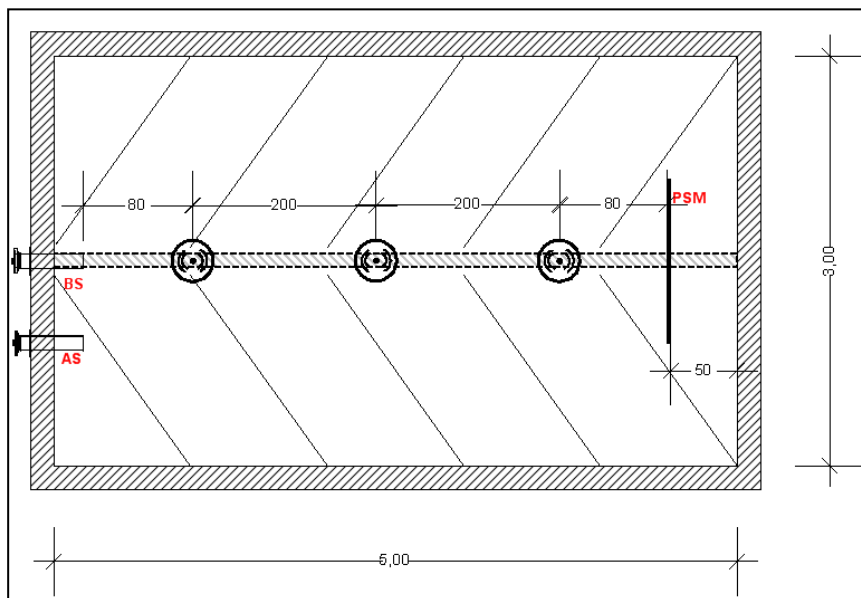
Skizze Pelletlager m. Schnecke u. bündigen Schrägen
